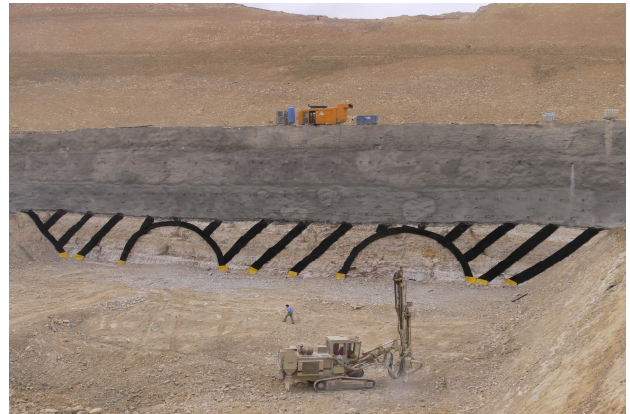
Mise en place du drainage et du béton projeté au niveau de la tête Nord du tunnel
